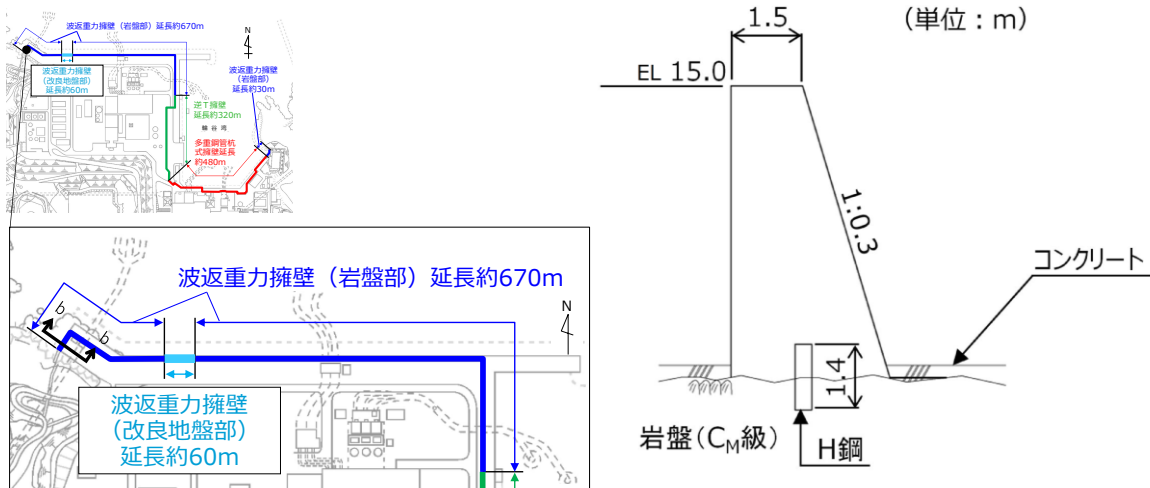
防波壁（波返重力擁壁）西端部（b - b 断面） 断面図
